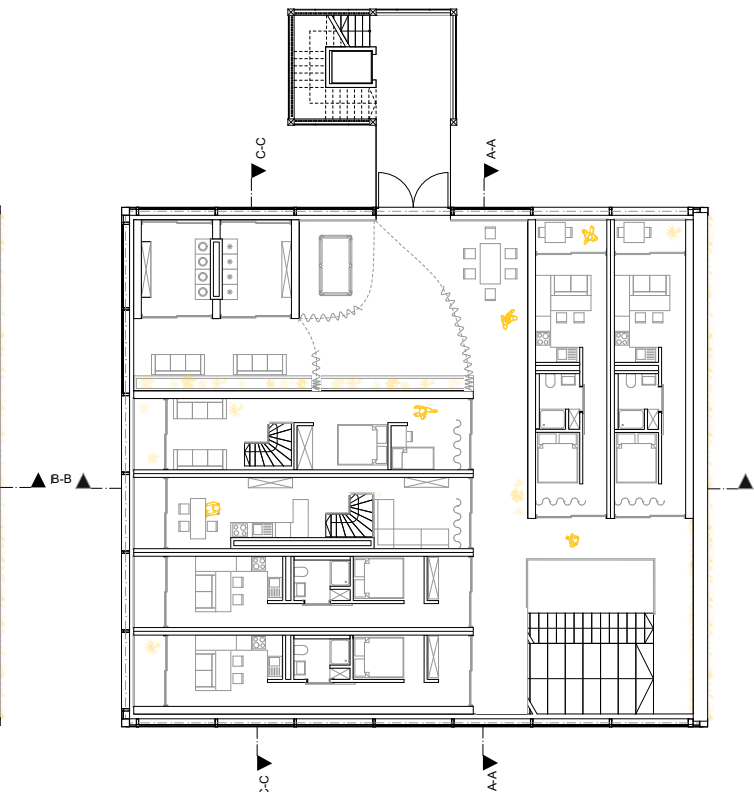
Grundriss 3. OG | M 1:300
